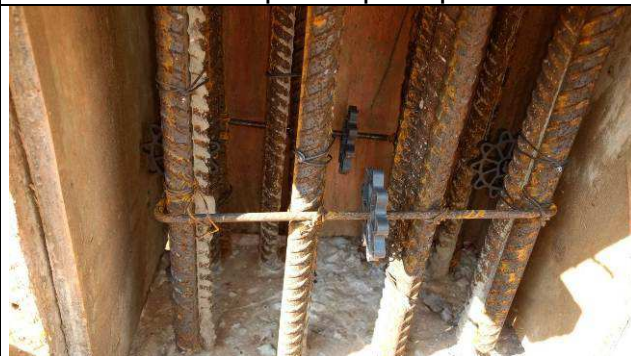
C: Formas e armaduras do pilar P26 do prédio principal.
